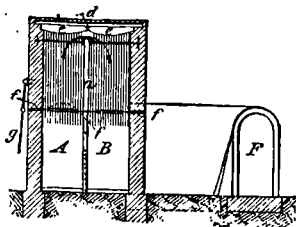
Chambre à poussière de Rösing; coupe transversale.
